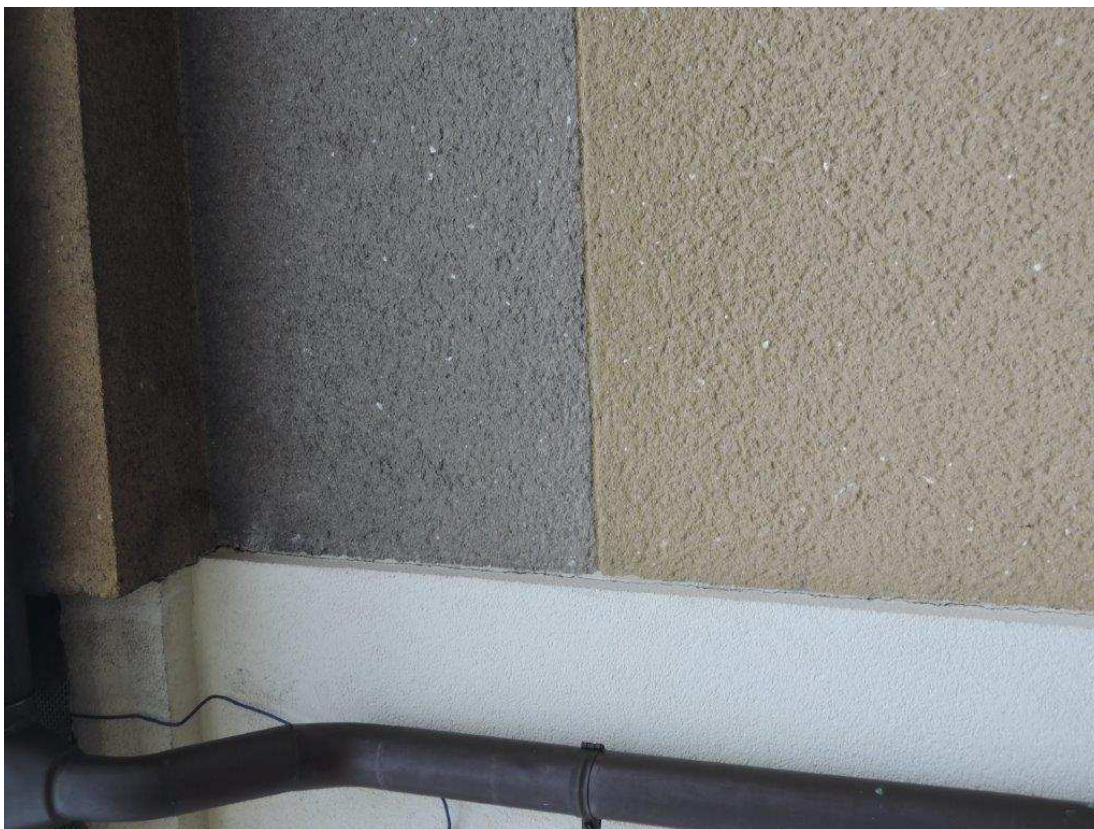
Pohled na západní část fasády – drobné trhliny v přechodu objektů
